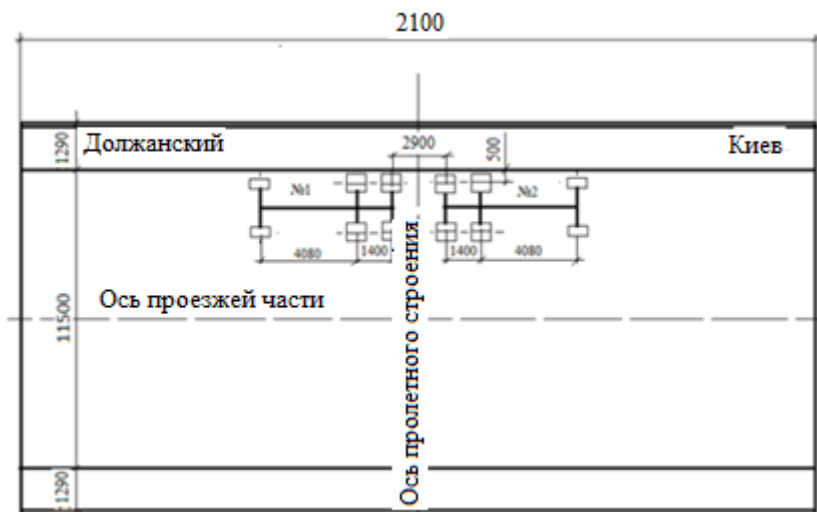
Установки испытательной нагрузки по схемам 1 и 3
